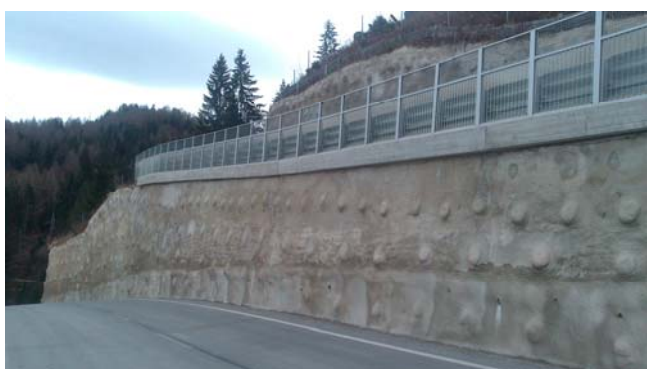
Spritzbetonwand Nr. 5 / parete in calcestruzzo proiettato n. 5
